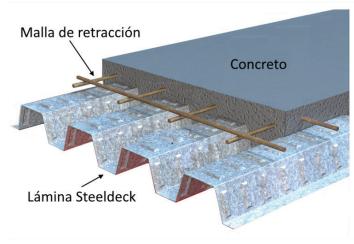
Conformación de la losa con lámina colaborante de SteelDeck
